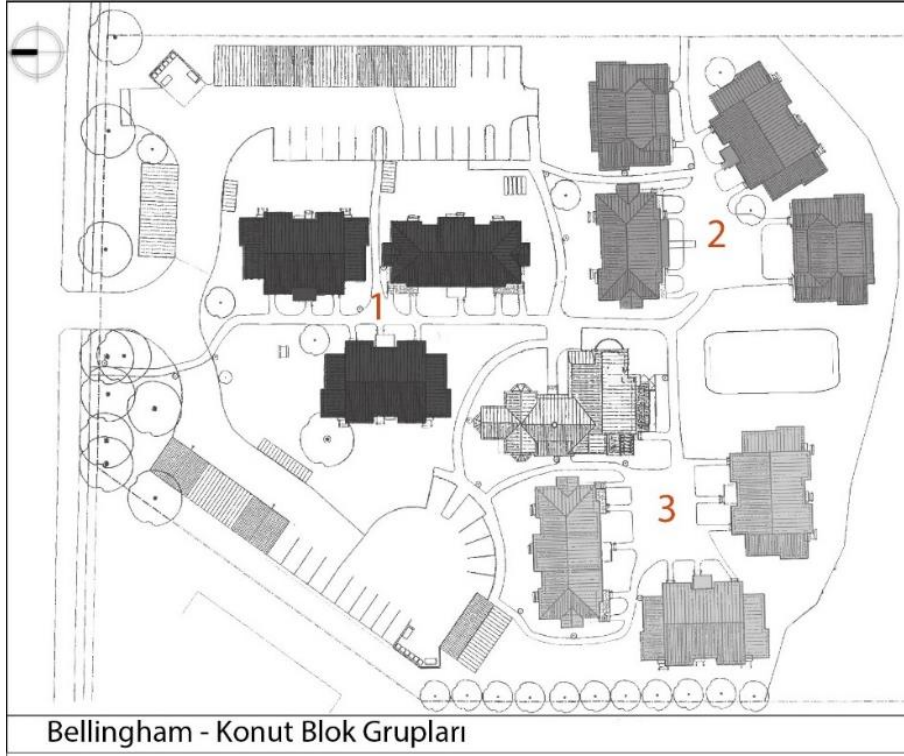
Bellingham Cohousing Vaziyet Planı (<https://bellcoho.com/>)
